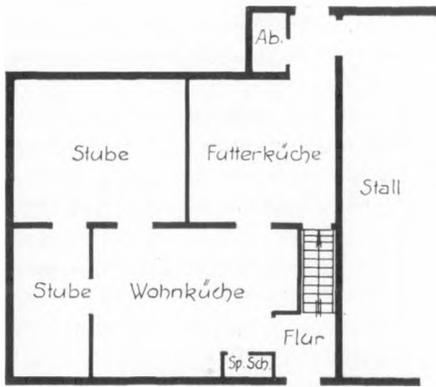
Angebautes Wohnhaus mit 3 Wohnräumen und Futterküche im Erdgeschoß. Zwei weitere Zimmer können im Dachgeschoß abseits der äußeren Giebelwand ausgebaut werden.
